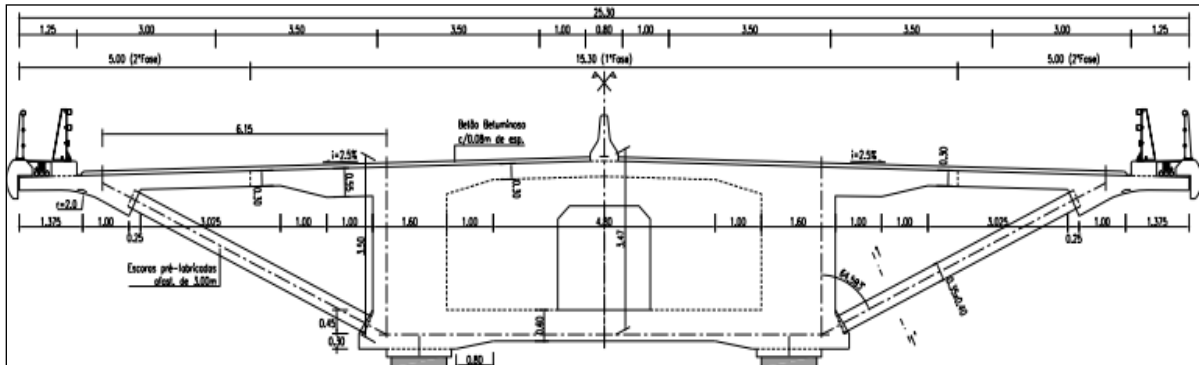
Secção transversal na zona sobre o pilar no SVN [22].
